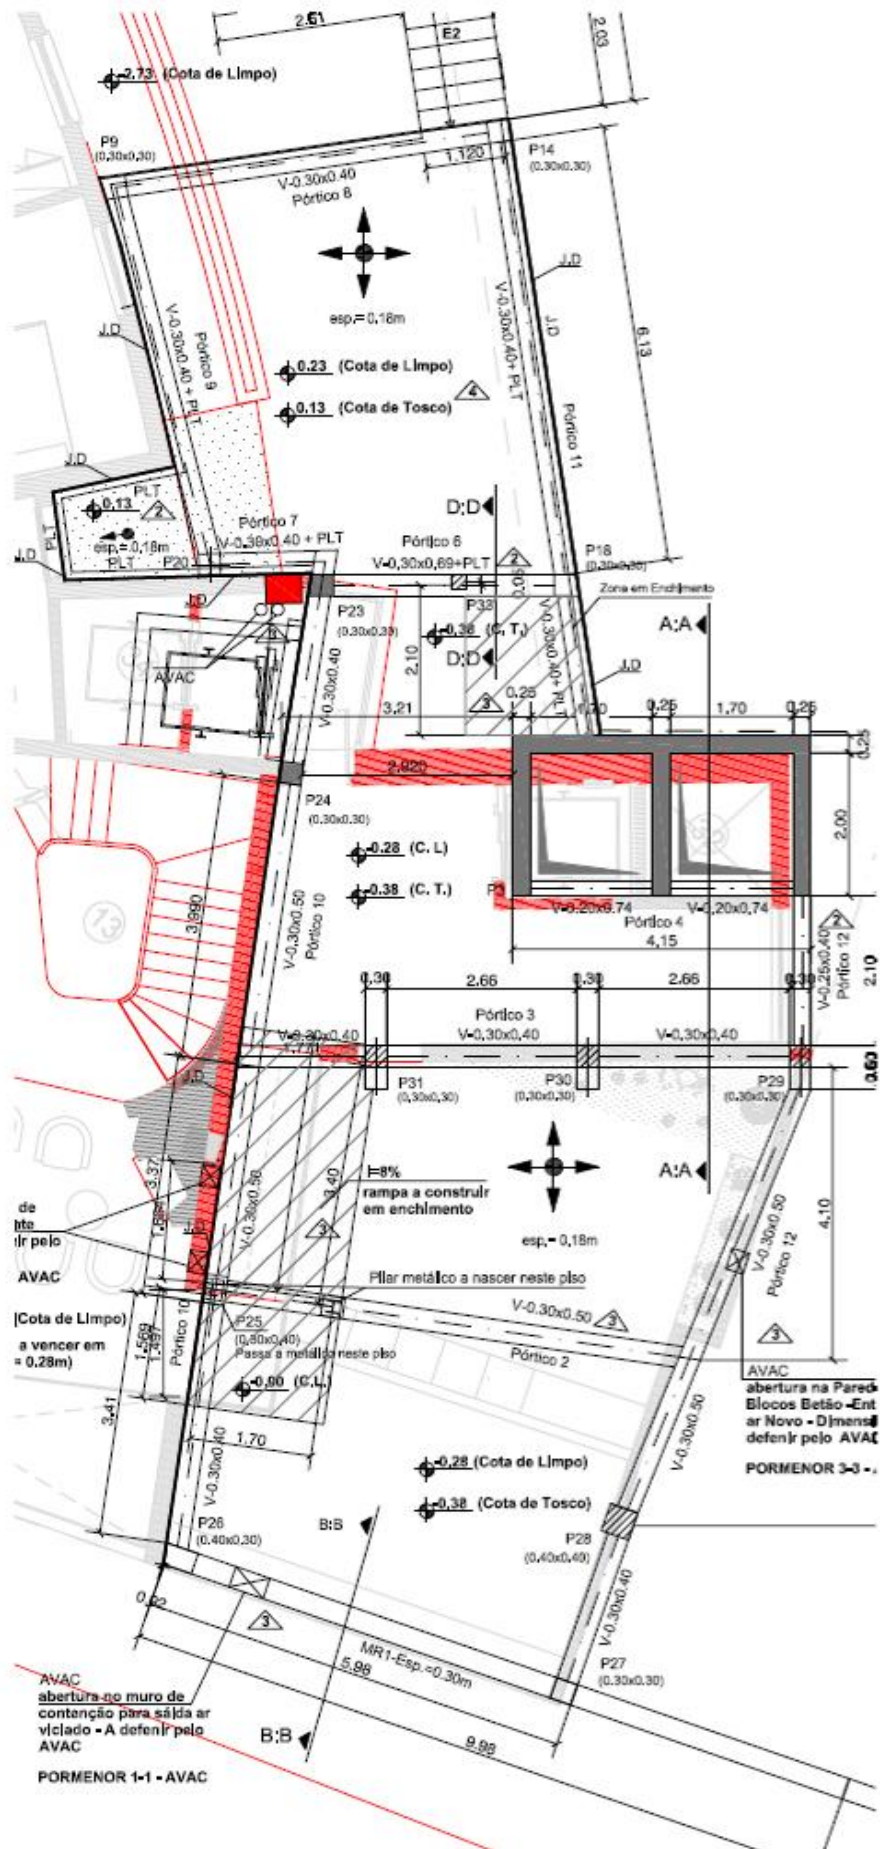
Planta do piso 0 - preparação dos trabalhos [AVicêncio A, 2017]
